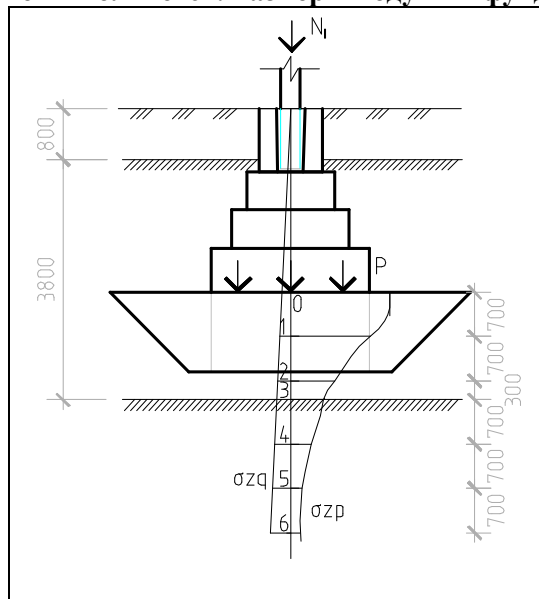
Схема расчета осадки фундамента на песчаной подушке
